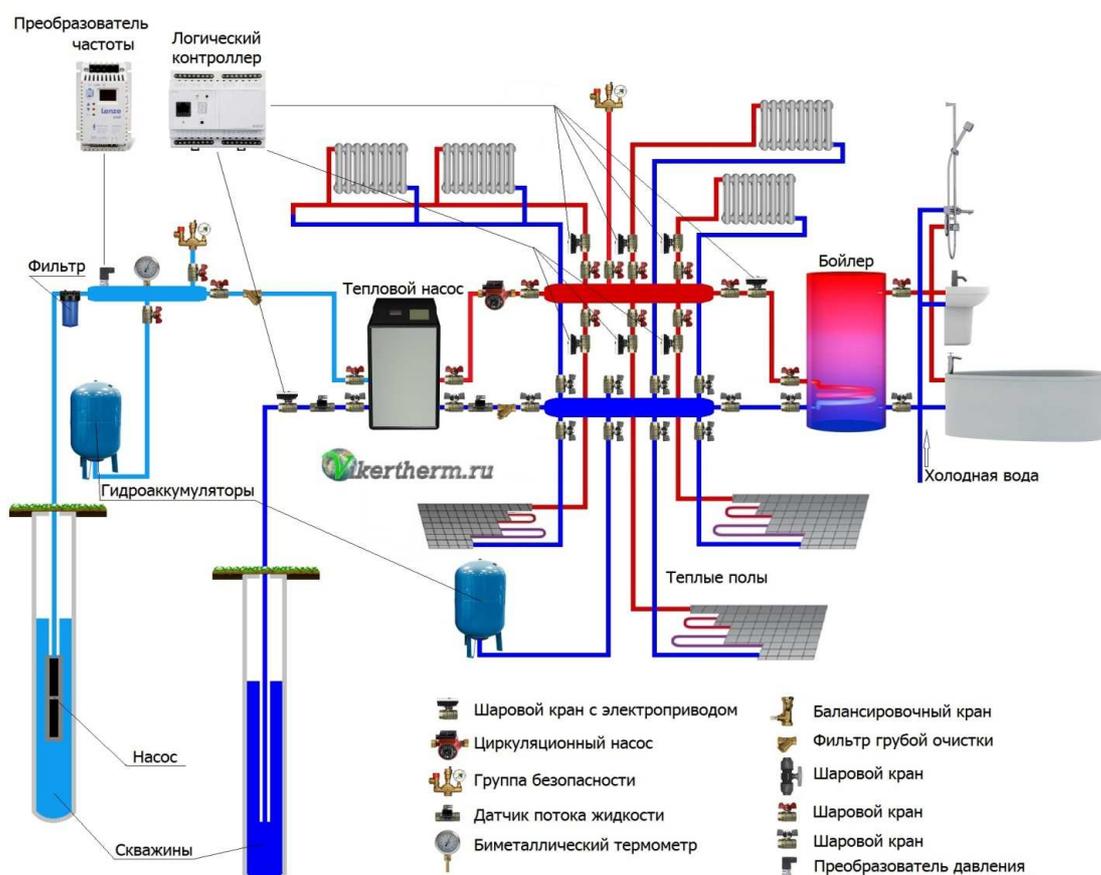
Схема работы геотермального теплового насоса открытого типа с отбором теплоты грунтовых вод.
